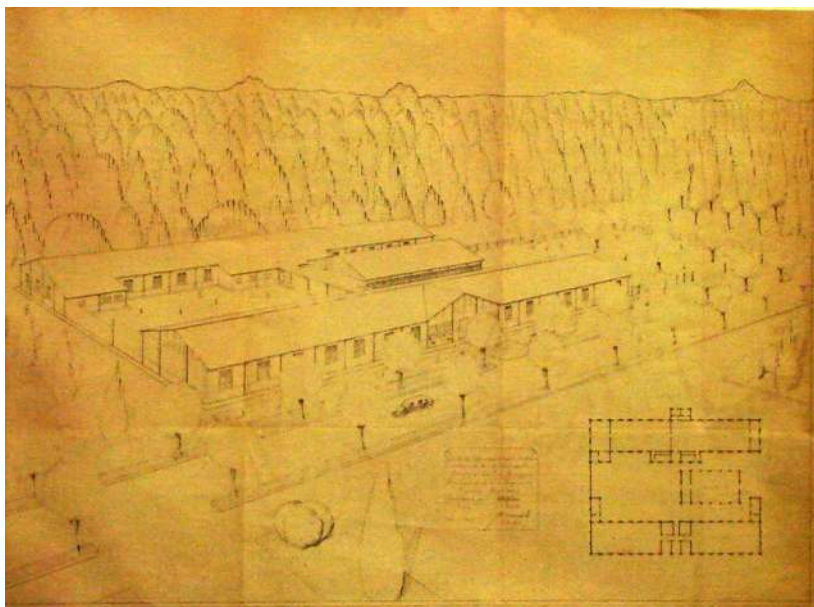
, 170 e 171 - Foto da fachada central, planta, desenho da fachada e perspectiva do conjunto (acervo SIOC e Museu Osório César)
